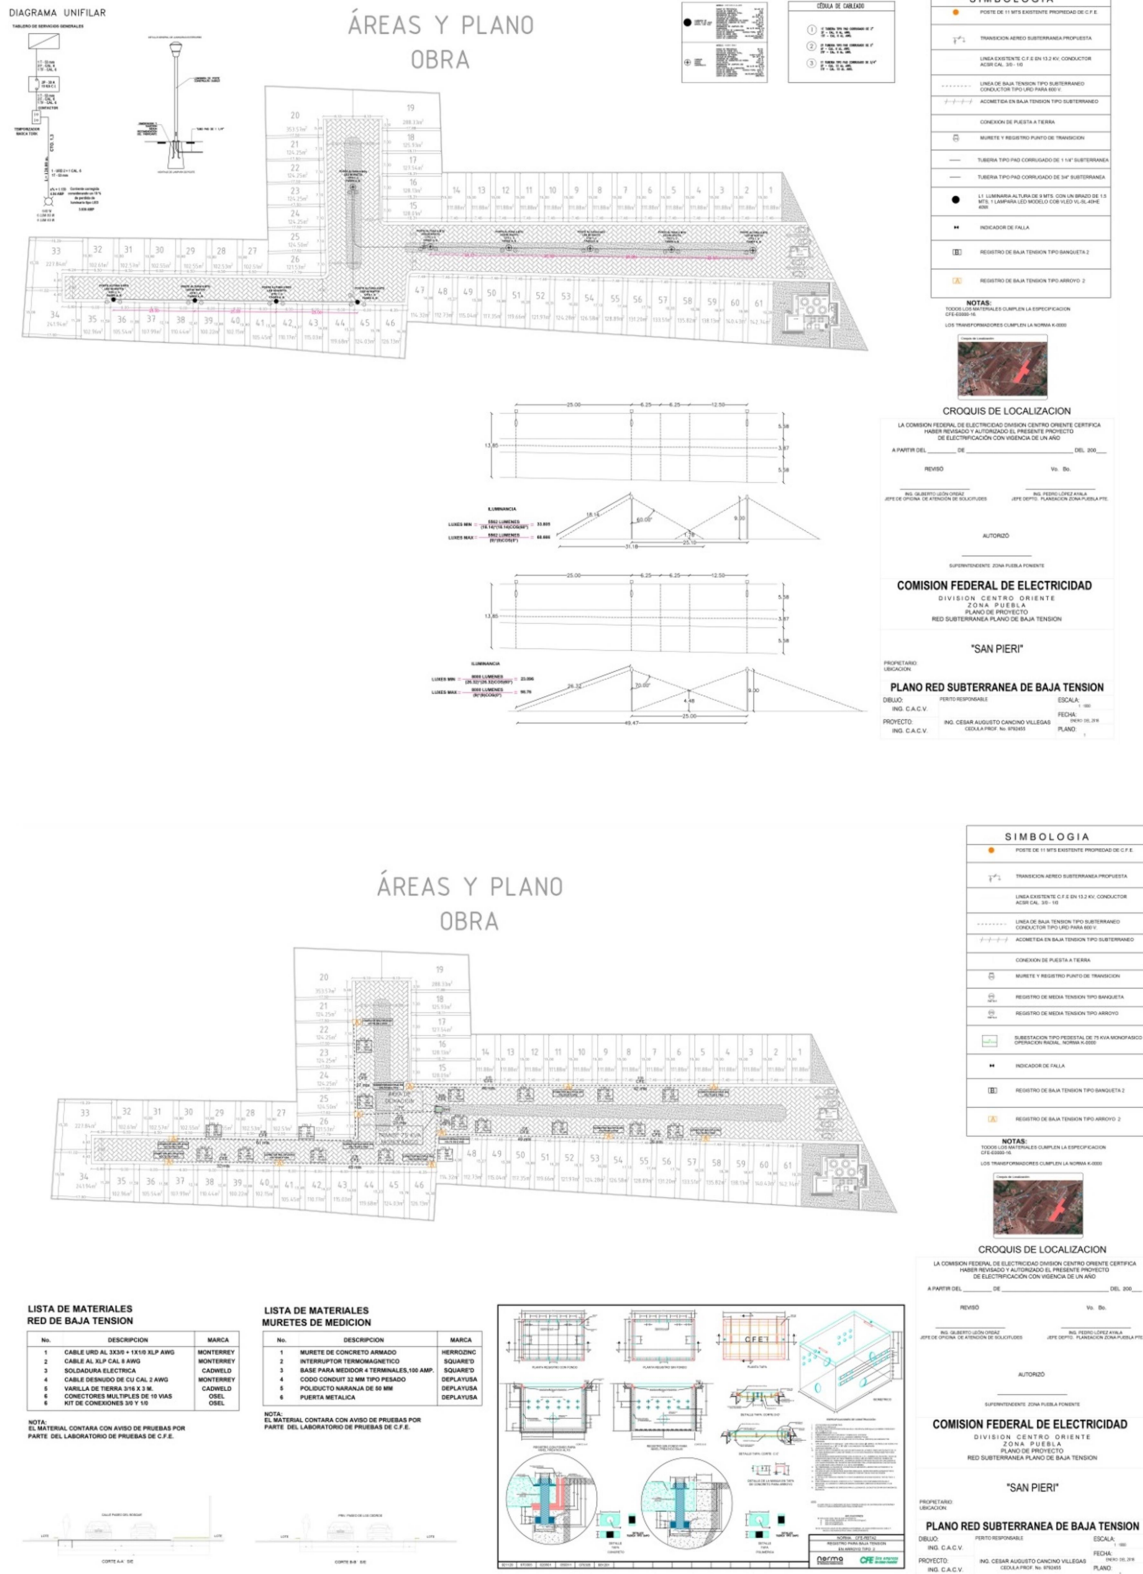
Planos de alta y baja tensión. Información de proyectos punto exacto.
